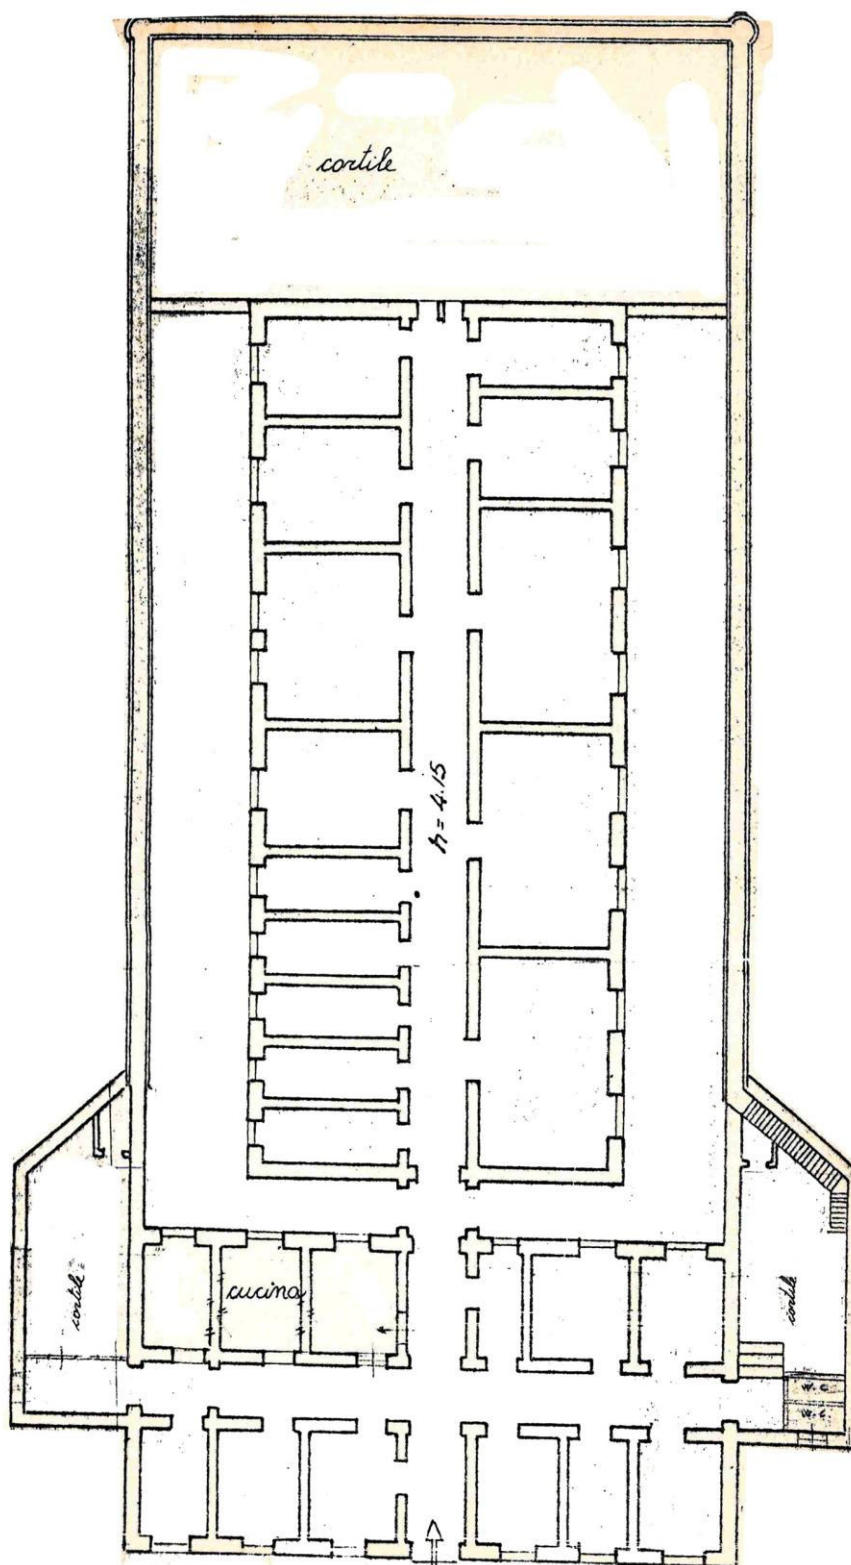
Planimetria fornita dall'Agenzia del Demanio, risalente al 1985
